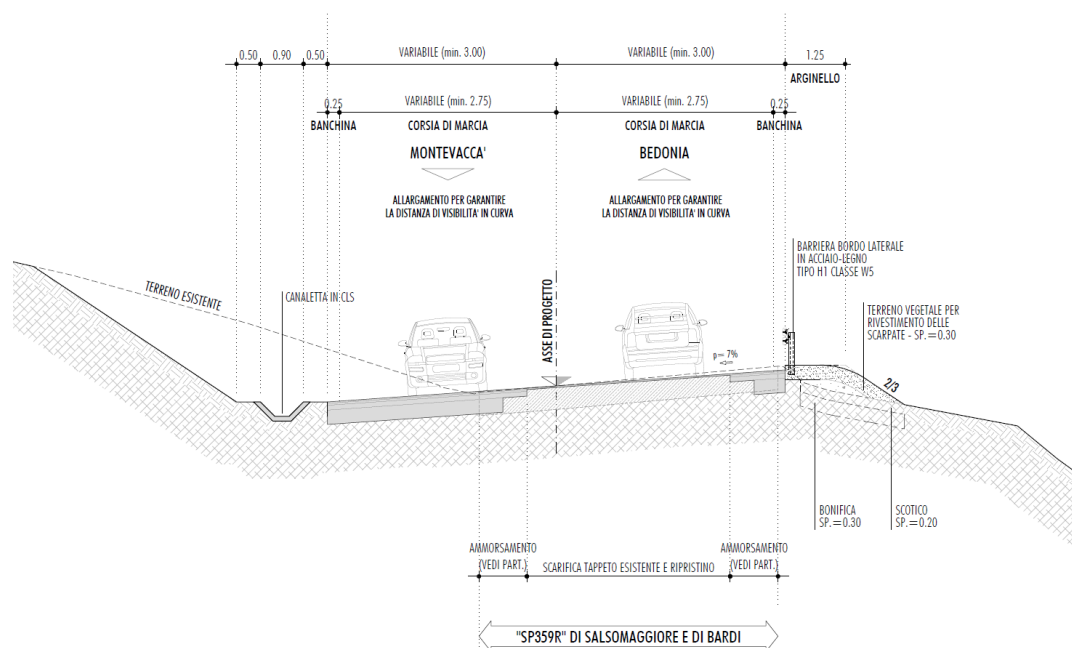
SEZIONE TIPO – AMPLIAMENTO LATO MONTE
